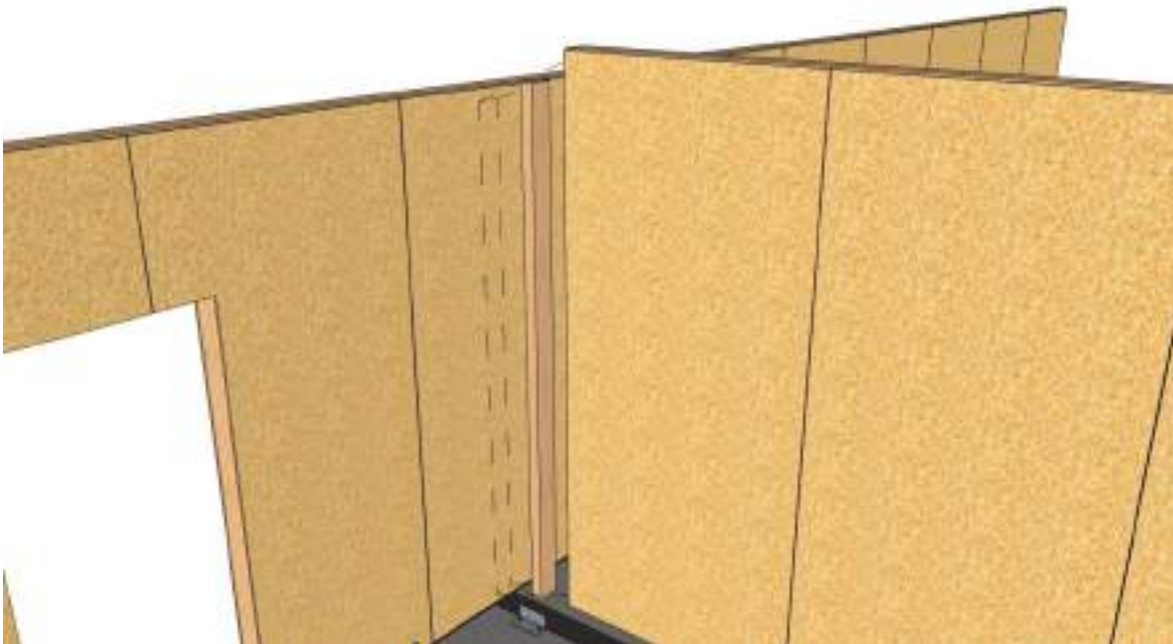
Mise en œuvre d'un montant de raccord permettant l'emboîtement du mur de refend / Couturage au droit des plaques de parement
